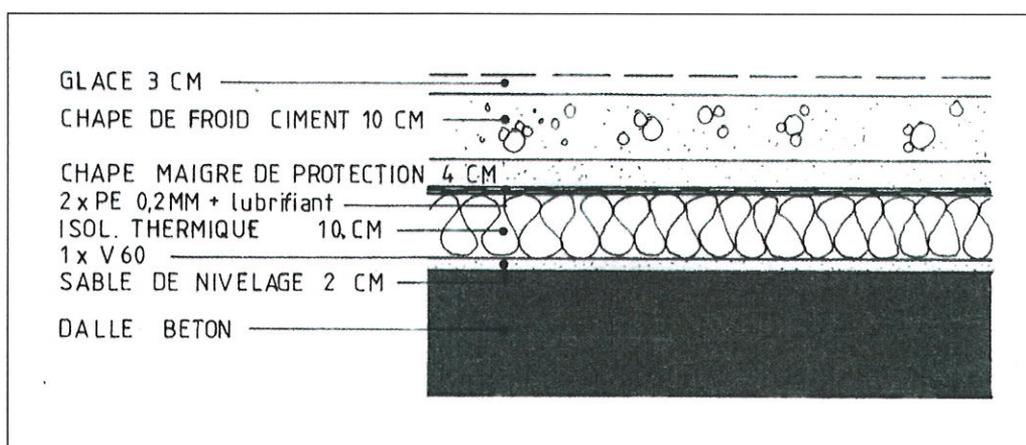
Coupe de la piste de froid (extrait du plan original)
